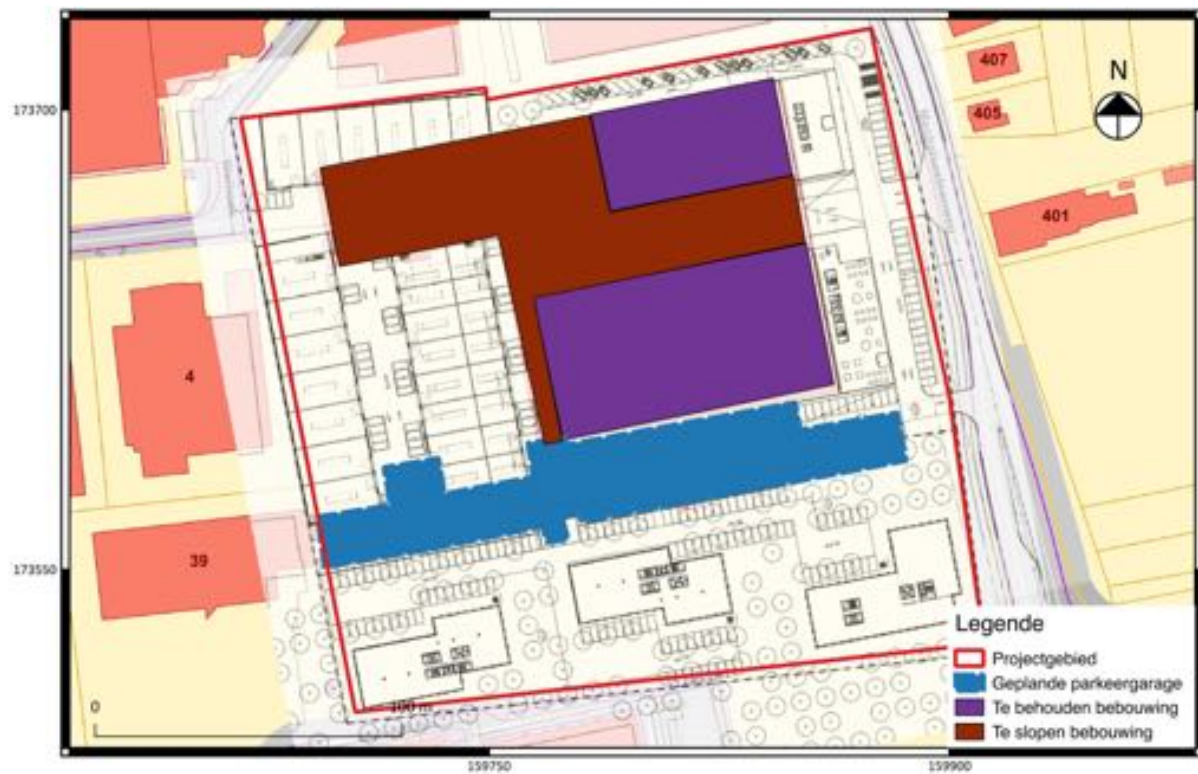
Uitleg bij de bouwplannen (overzicht van de te slopen en de te behouden bebouwing + aanduiding van het geplande parkeergebouw).
